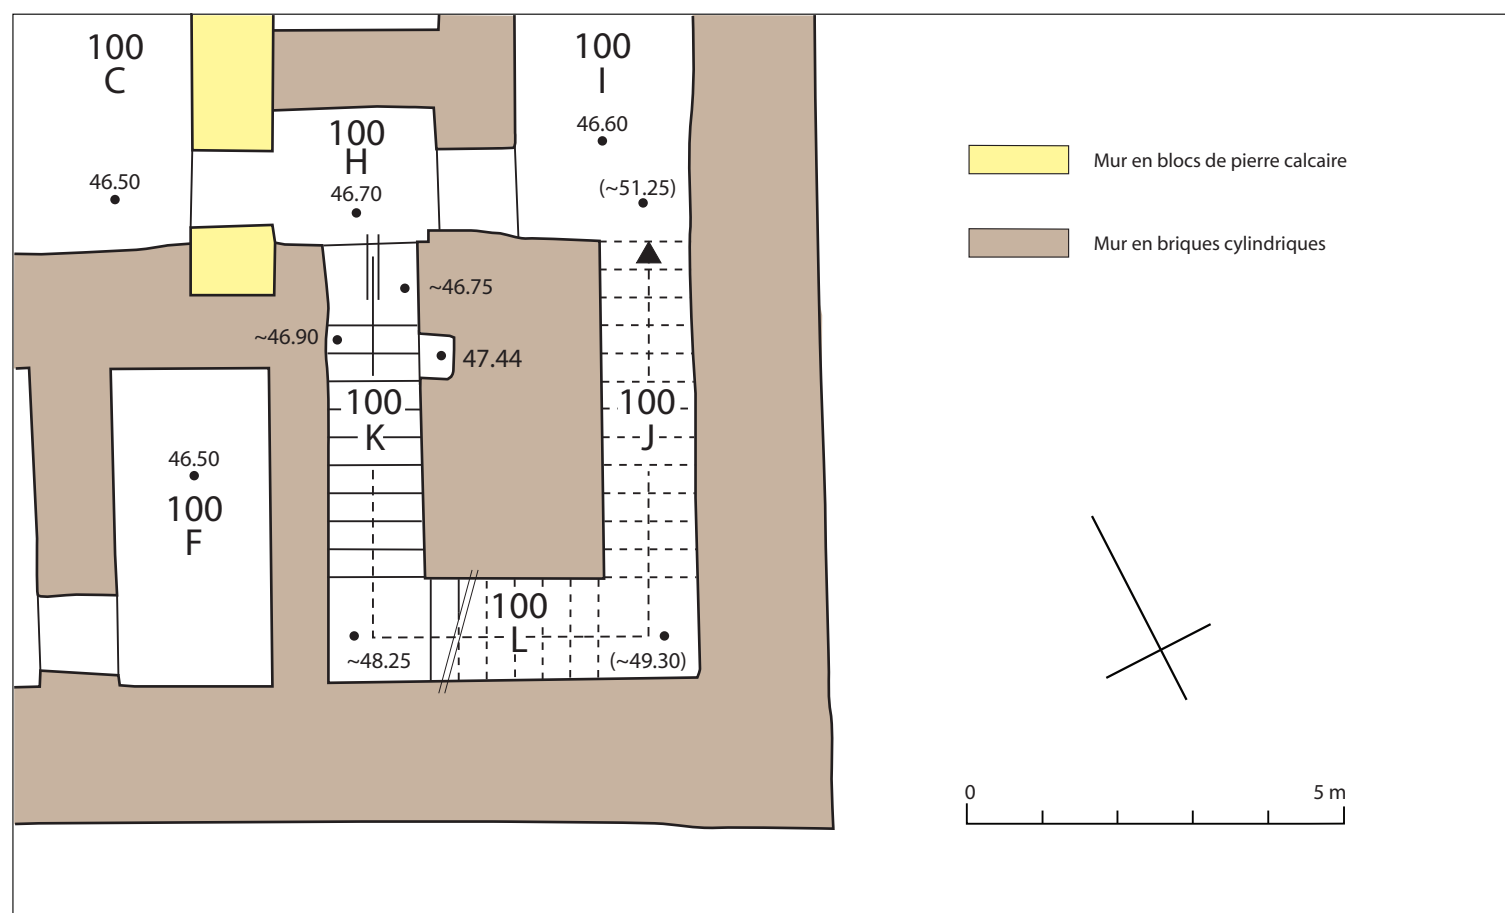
Angle sud-est du palais, plan schématique de l'escalier
